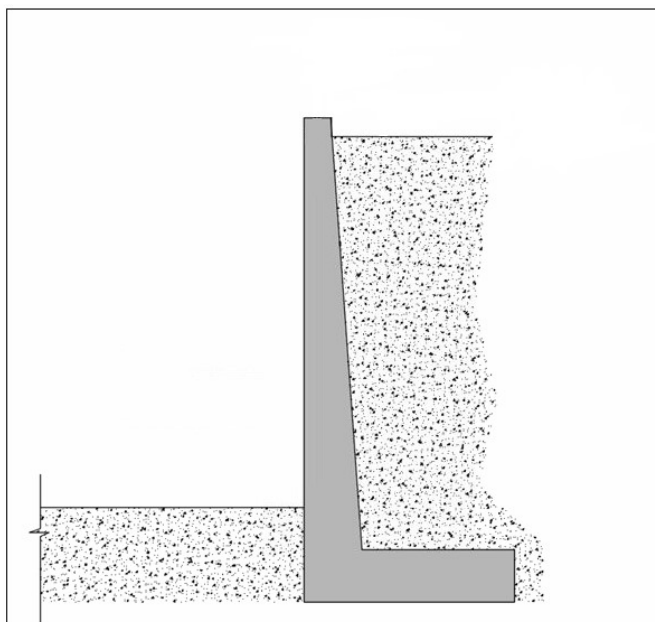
Perfil Esquemático Murete de Hormigón Armado
